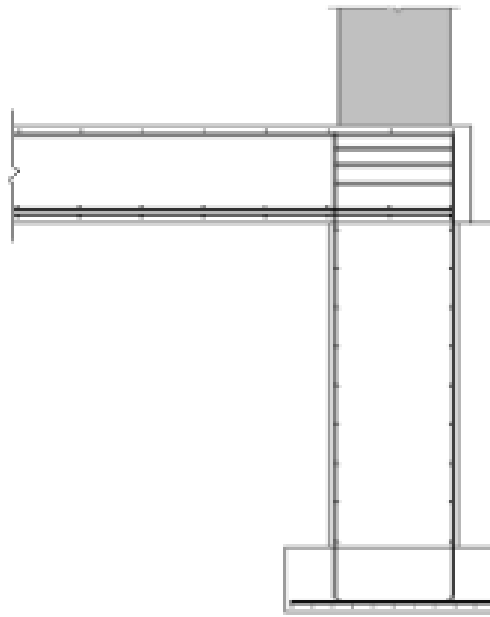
Армування стрічкового фундаменту в розрізі
